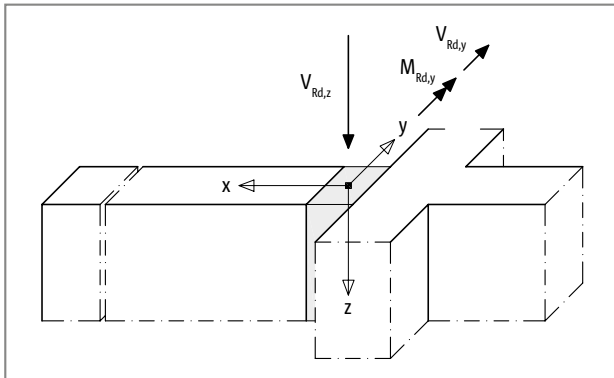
Schöck Isokorb® T type W: Sign rule for the design
